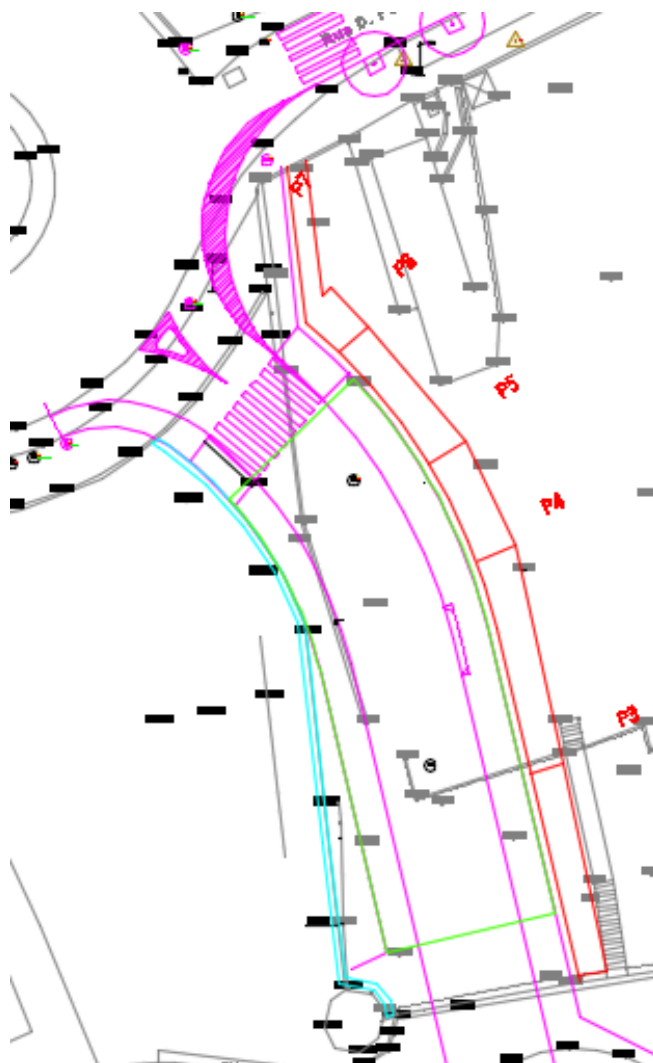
Planta de implantação do enrocamento (destacada a verde).
